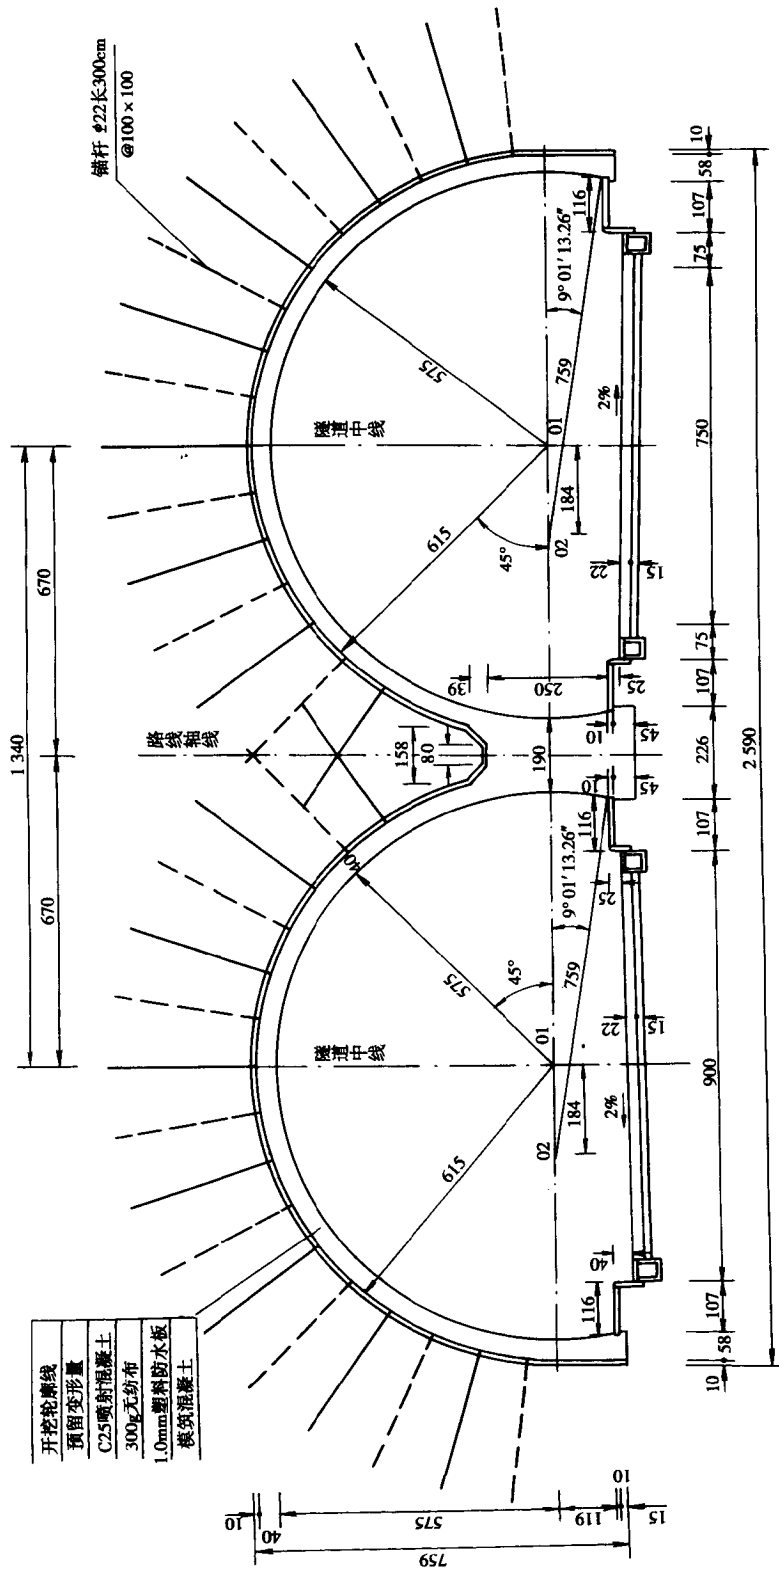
IV 类衬砌断面图(尺寸单位:cm)
